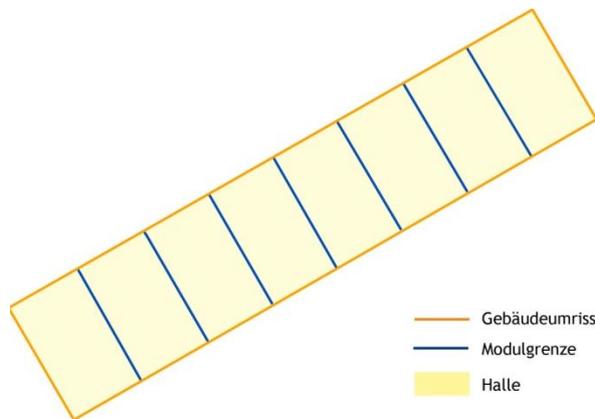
Grundriss Gebäude 5 (Quelle: (Quelle: Technisches Büro DI Bienert KG - Bestandsplan Gewerbepark Wienerstraße 114 GmbH , eigene Bearbeitung))
